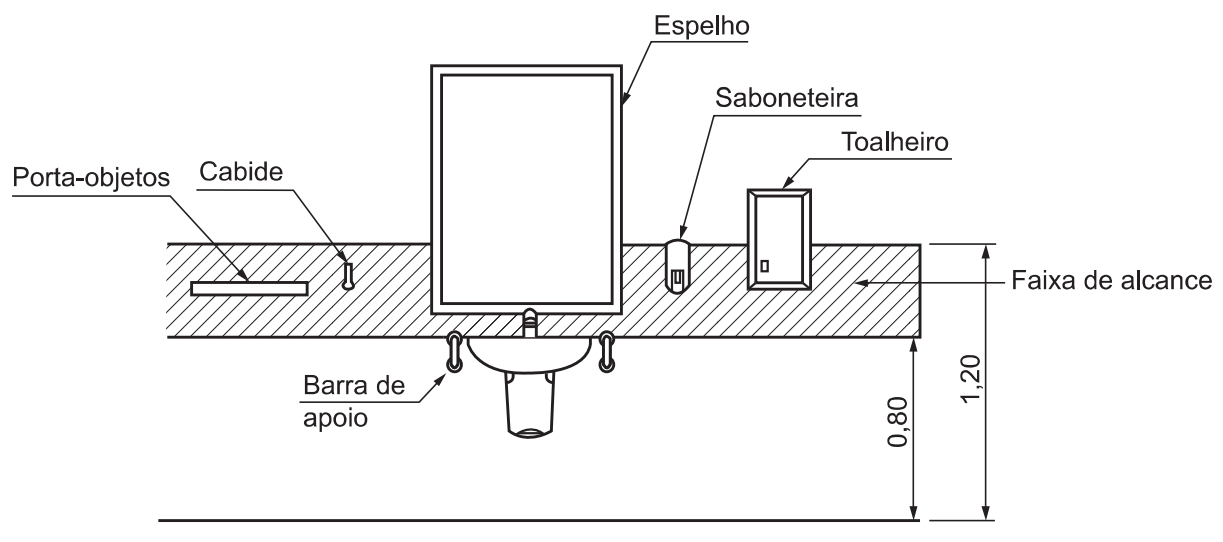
Faixa de alcance de acessórios junto ao lavatório – Vista frontal
